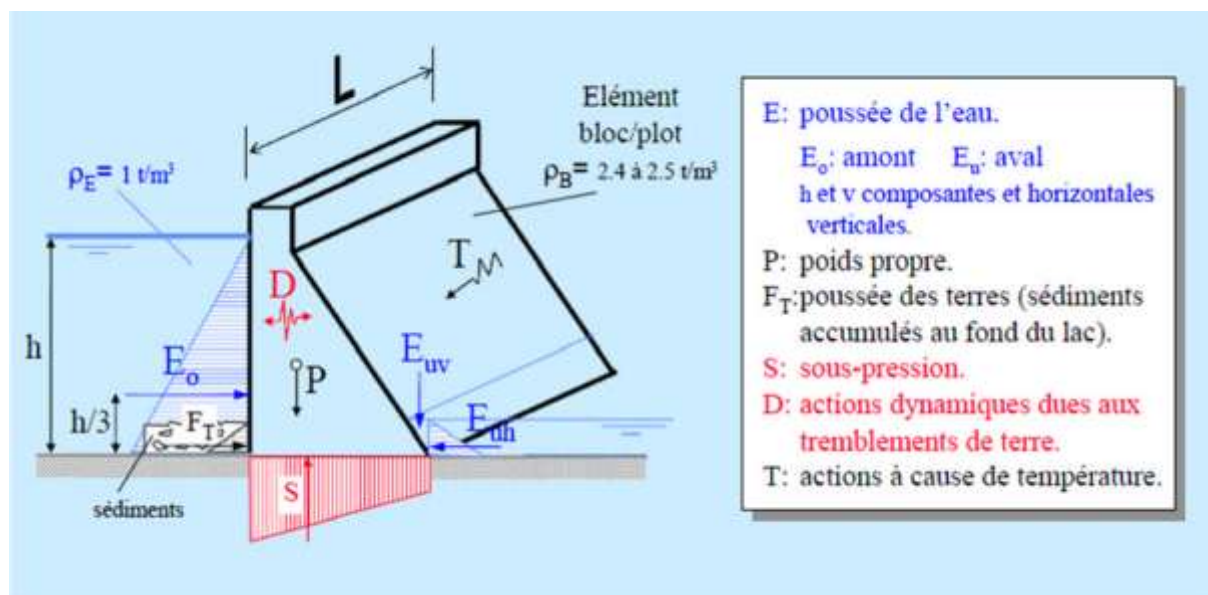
Schéma des actions agissantes sur un barrage poids
